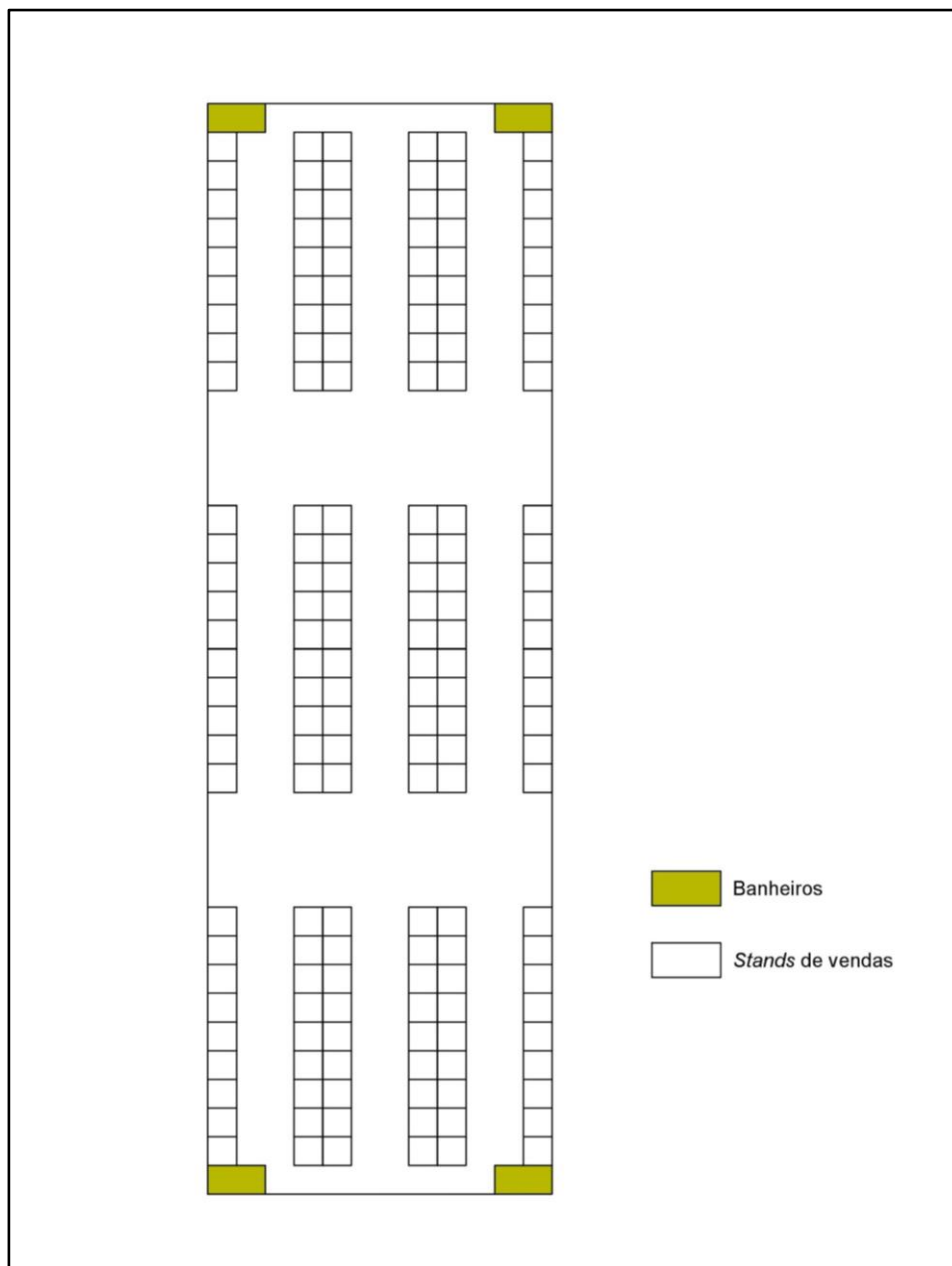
Planta do primeiro pavimento dos pavilhões de comércio varejista (Escala 1:1.000)
